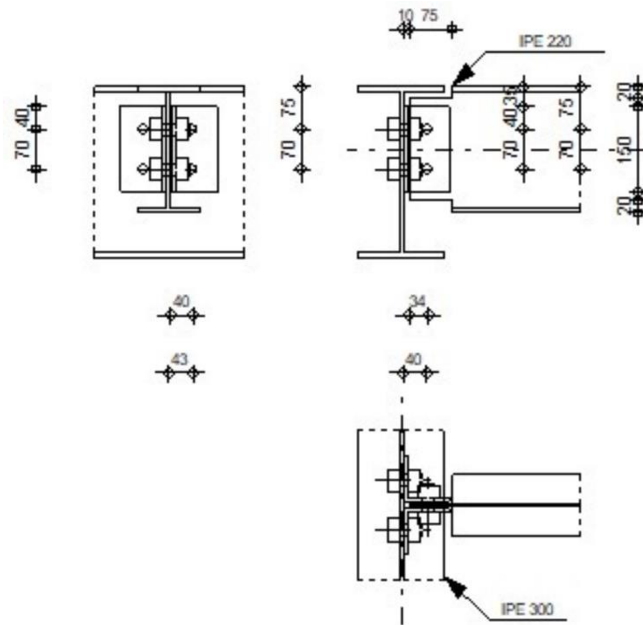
Disposition constructive des boulons (assemblage poutre-solive).
